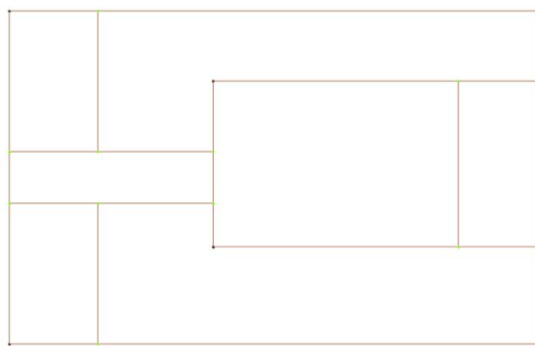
2: Schema semplificato della tipologia in pianta più diffusa, nel caso di edificio rettangolare con corte interna
